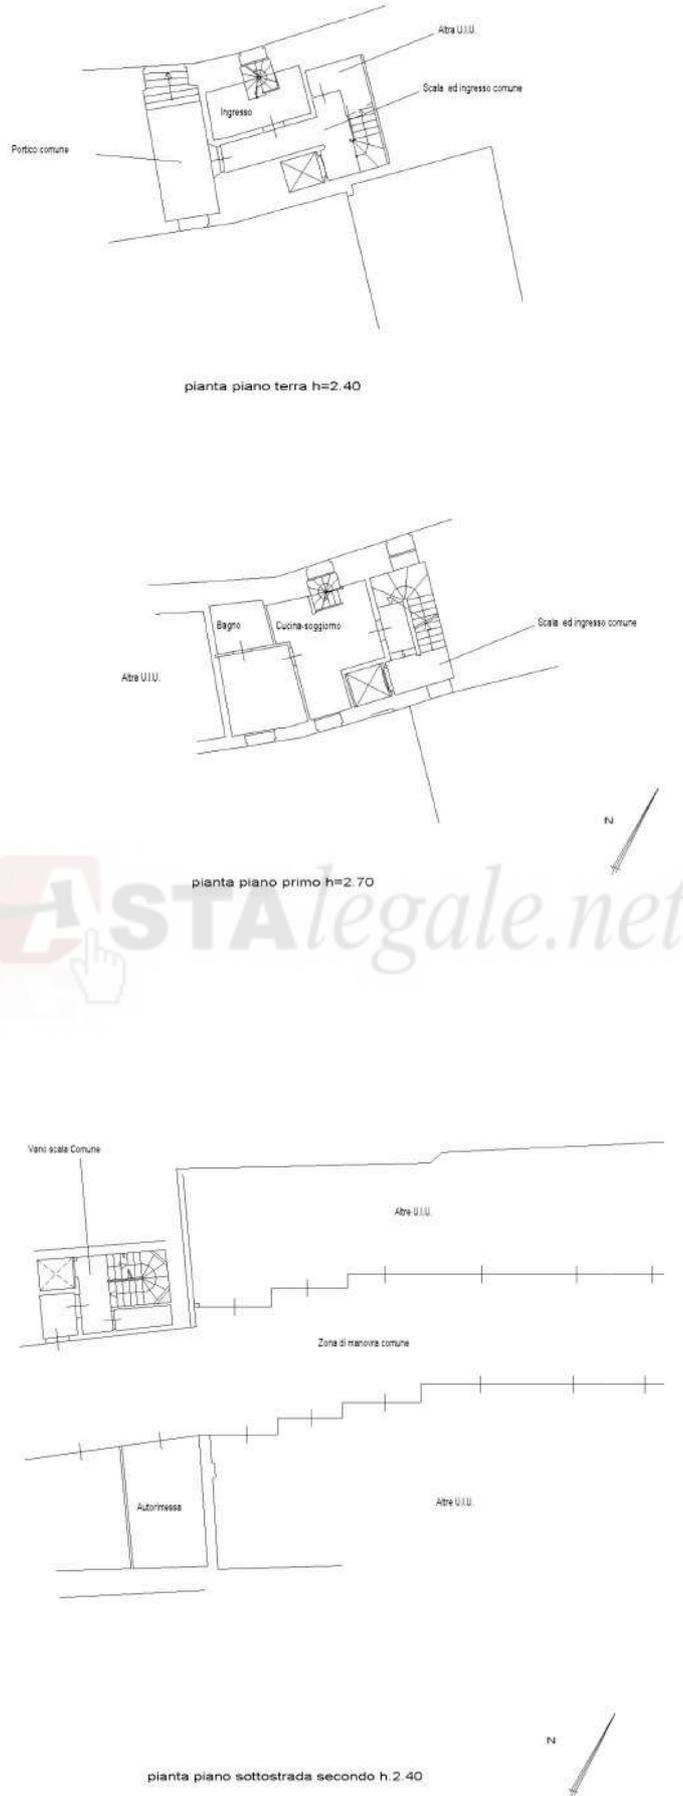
Estratto planimetrie catastali mapp. 602 sub. 12 e mapp. 602 sub 114 – elaborati non in scala
